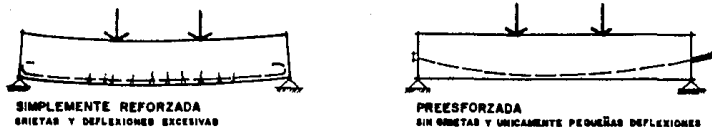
VIGA DE CONCRETO UTILIZANDO ACERO DE ALTA RESISTENCIA.
